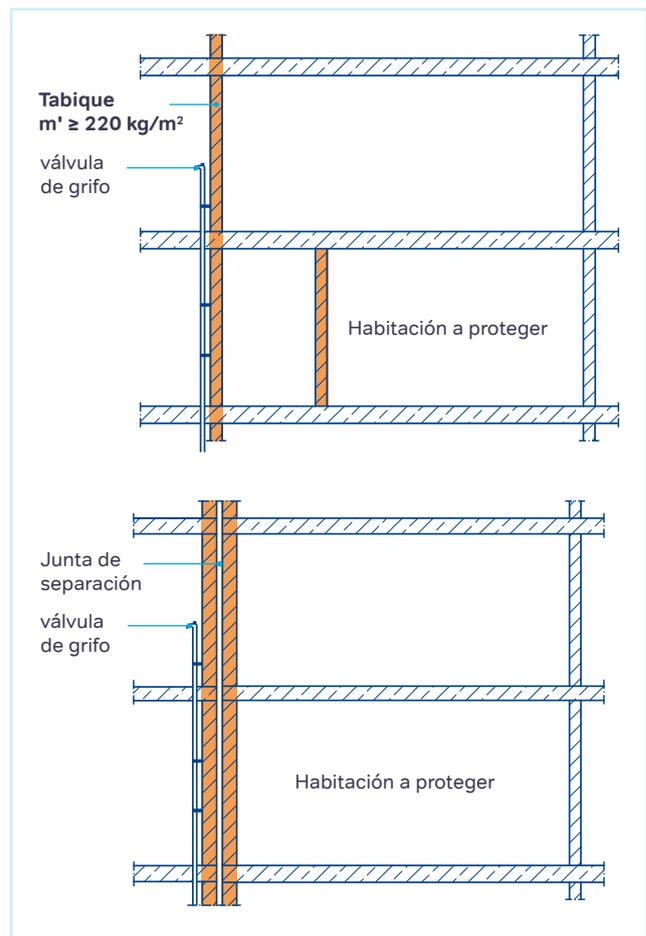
Disposición de los accesorios del grupo de accesorios II.
